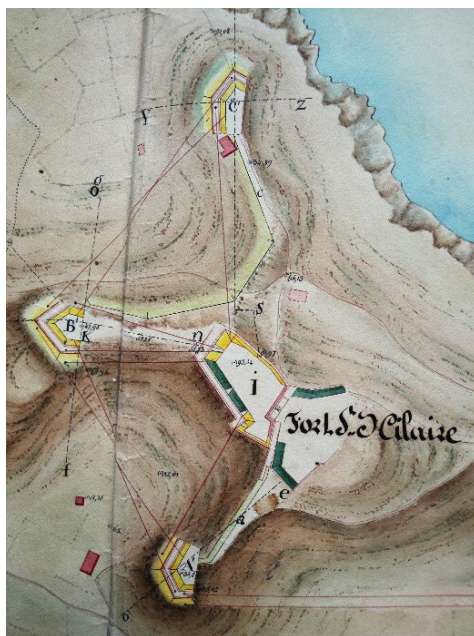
Plan de Masse des Projets d'amélioration demandés pour la Place de Porto Ferrajo. ISGAG, Ft865, dettaglio
